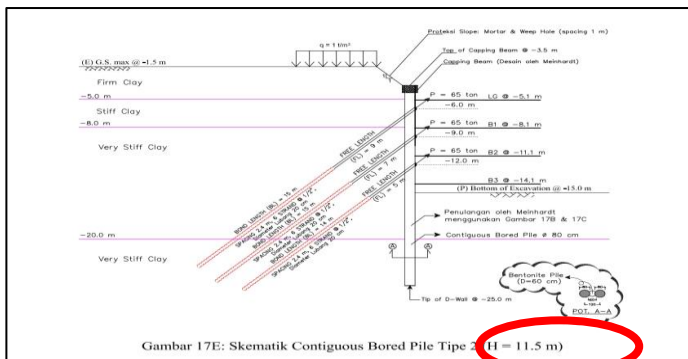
Denah pondasi dan pengaman galian tower Orllins
